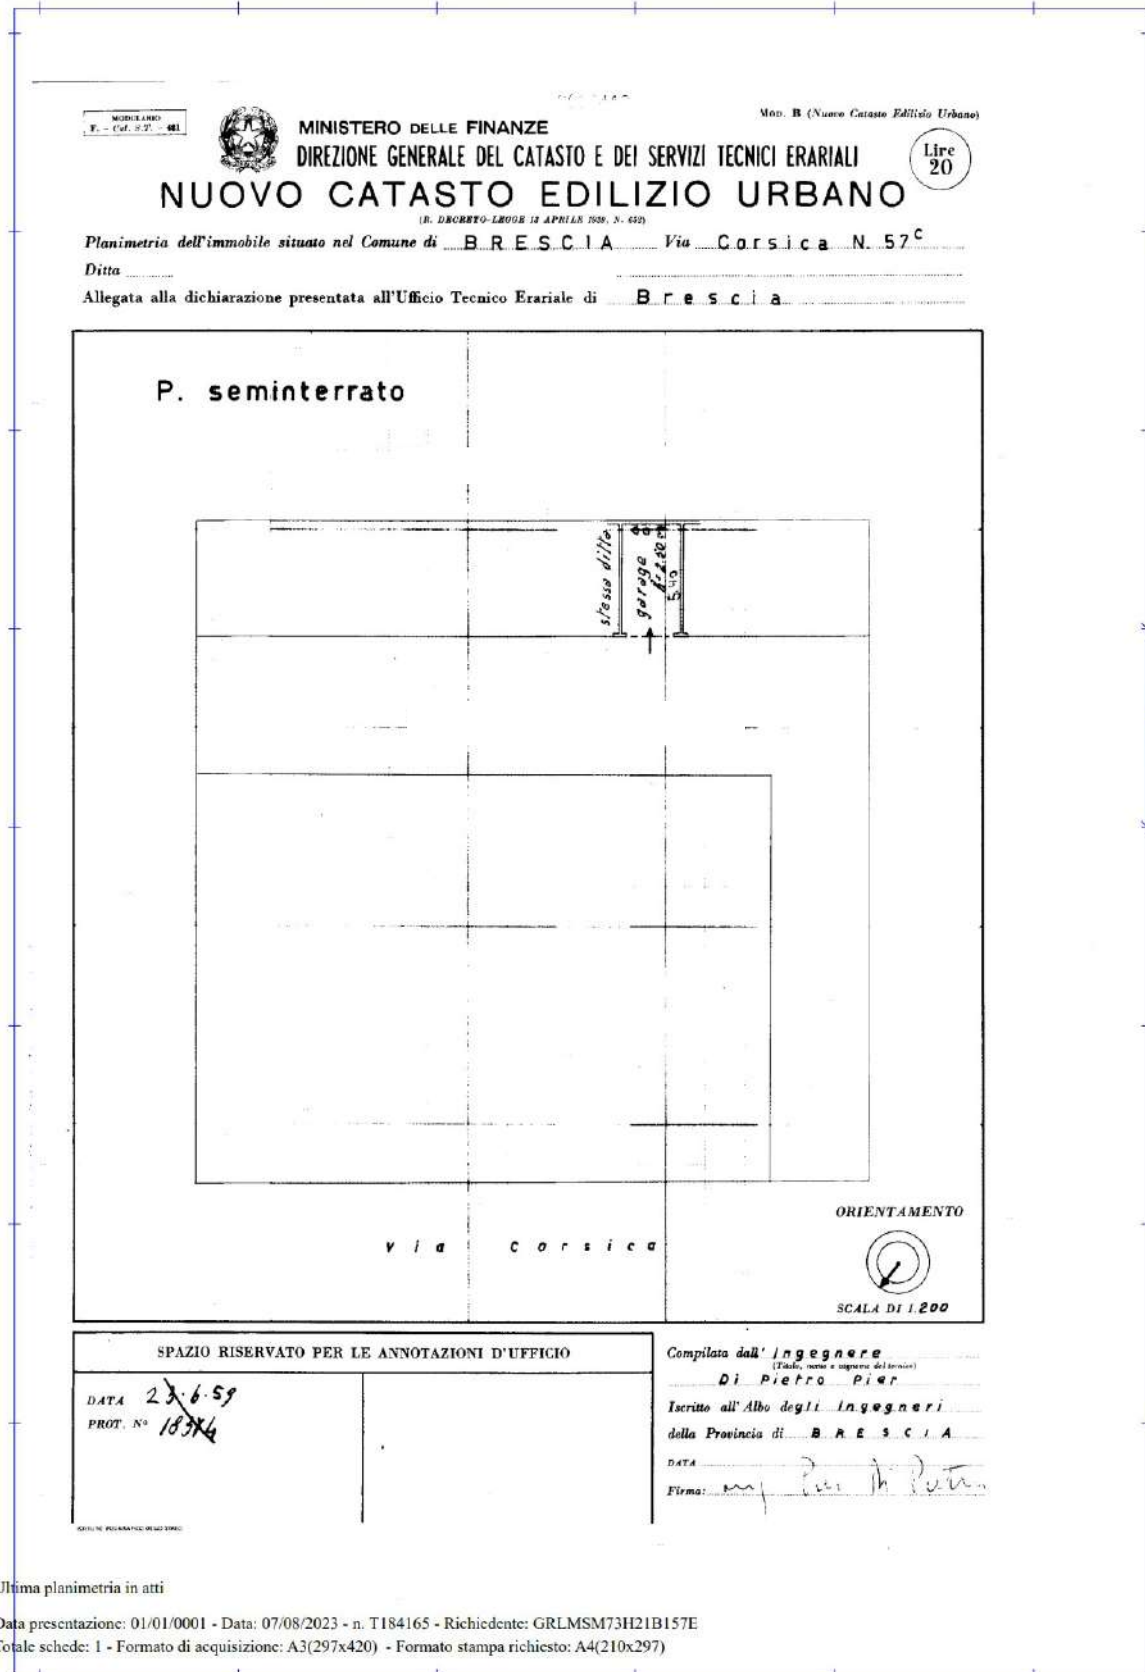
Estratto planimetria – Sez. SNA fg.6 Part. 4095 sub 5
